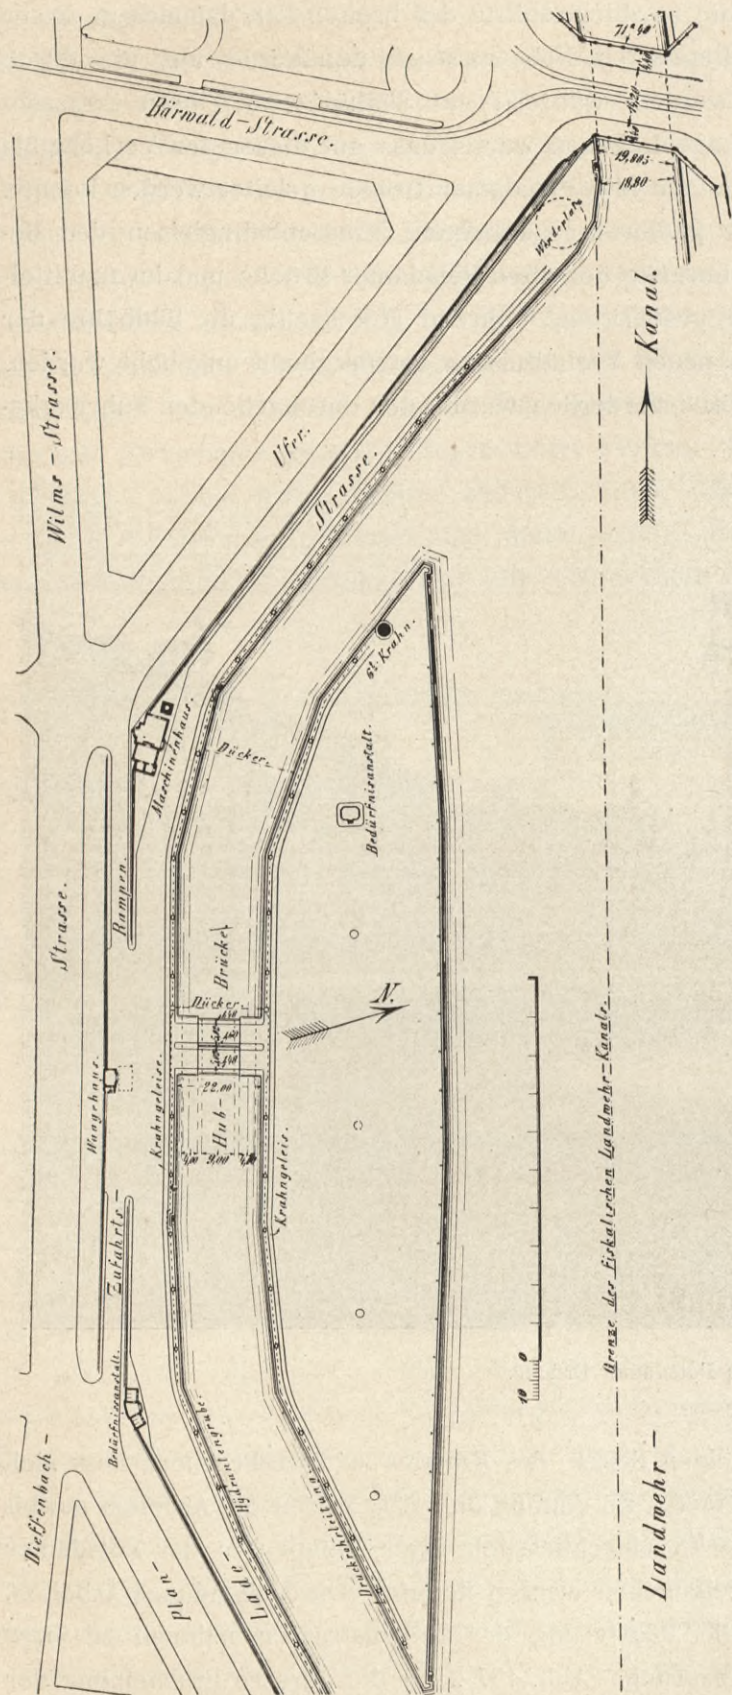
Lageplan des städtischen Urban-Hafens mit der Hub-Brücke.
